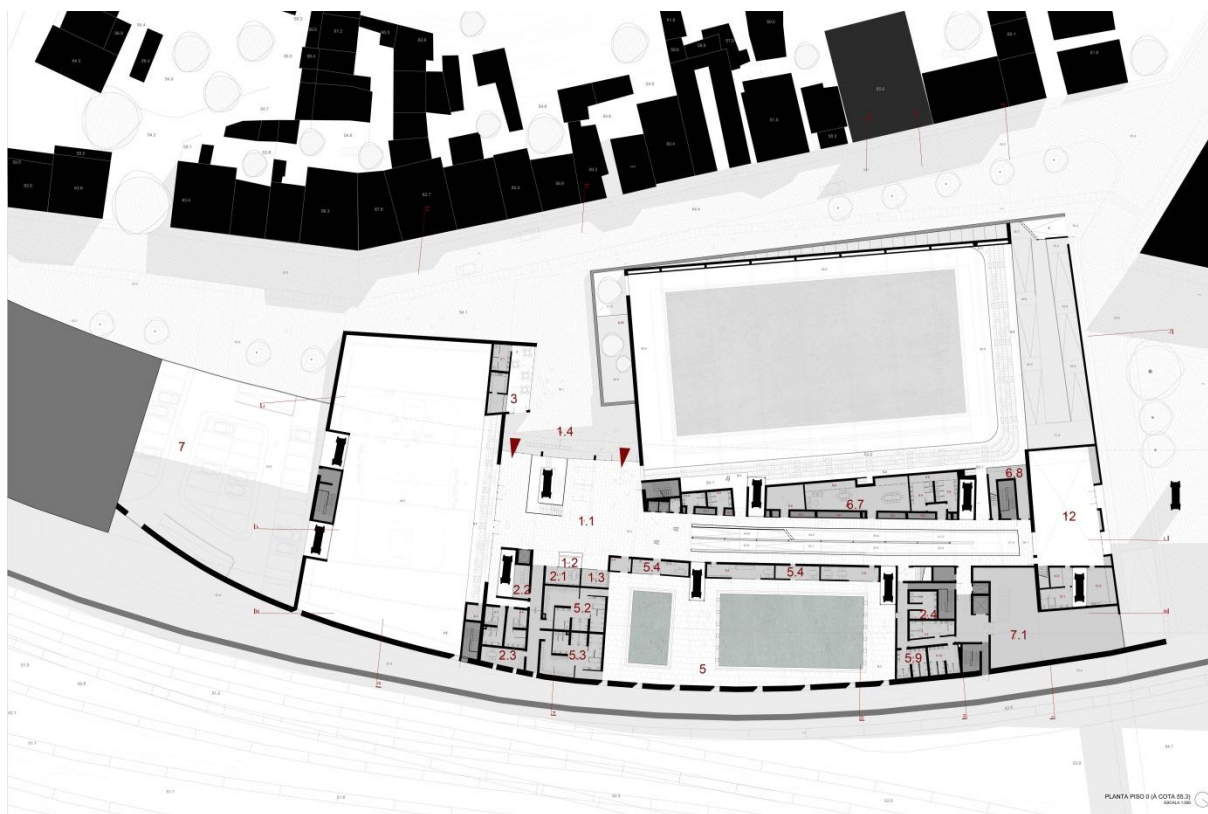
Planta Piso 0 – localização dos espaços principais.
